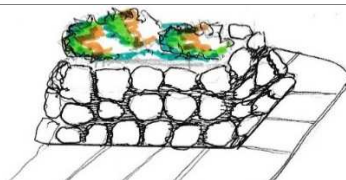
Premisa Tecnológica-constructiva 2. Fuente: Elaboración propia, 2018.
